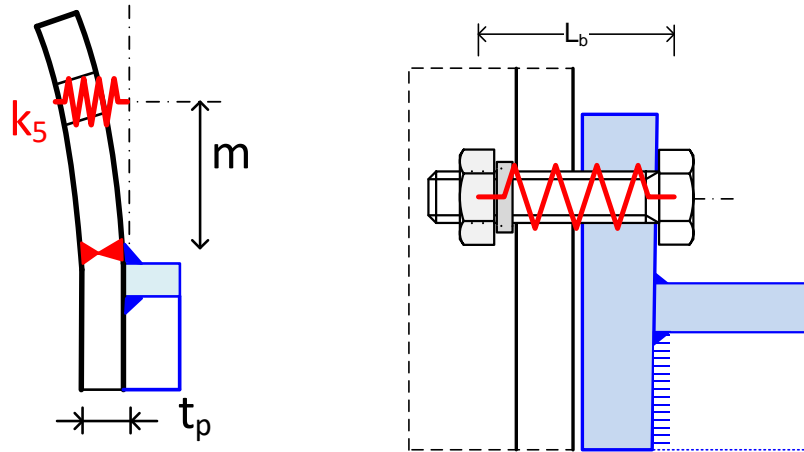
Rigidez de la chapa frontal a flexión (izquierda) y de una fila de tornillos (derecha)
